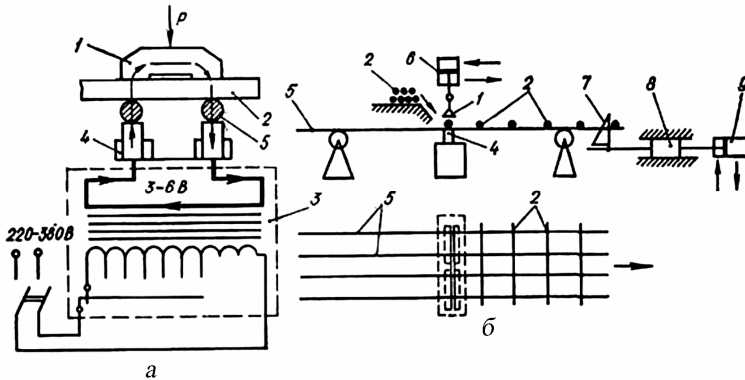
Конструкція і принцип роботи машин для зварювання арматурних сіток:
